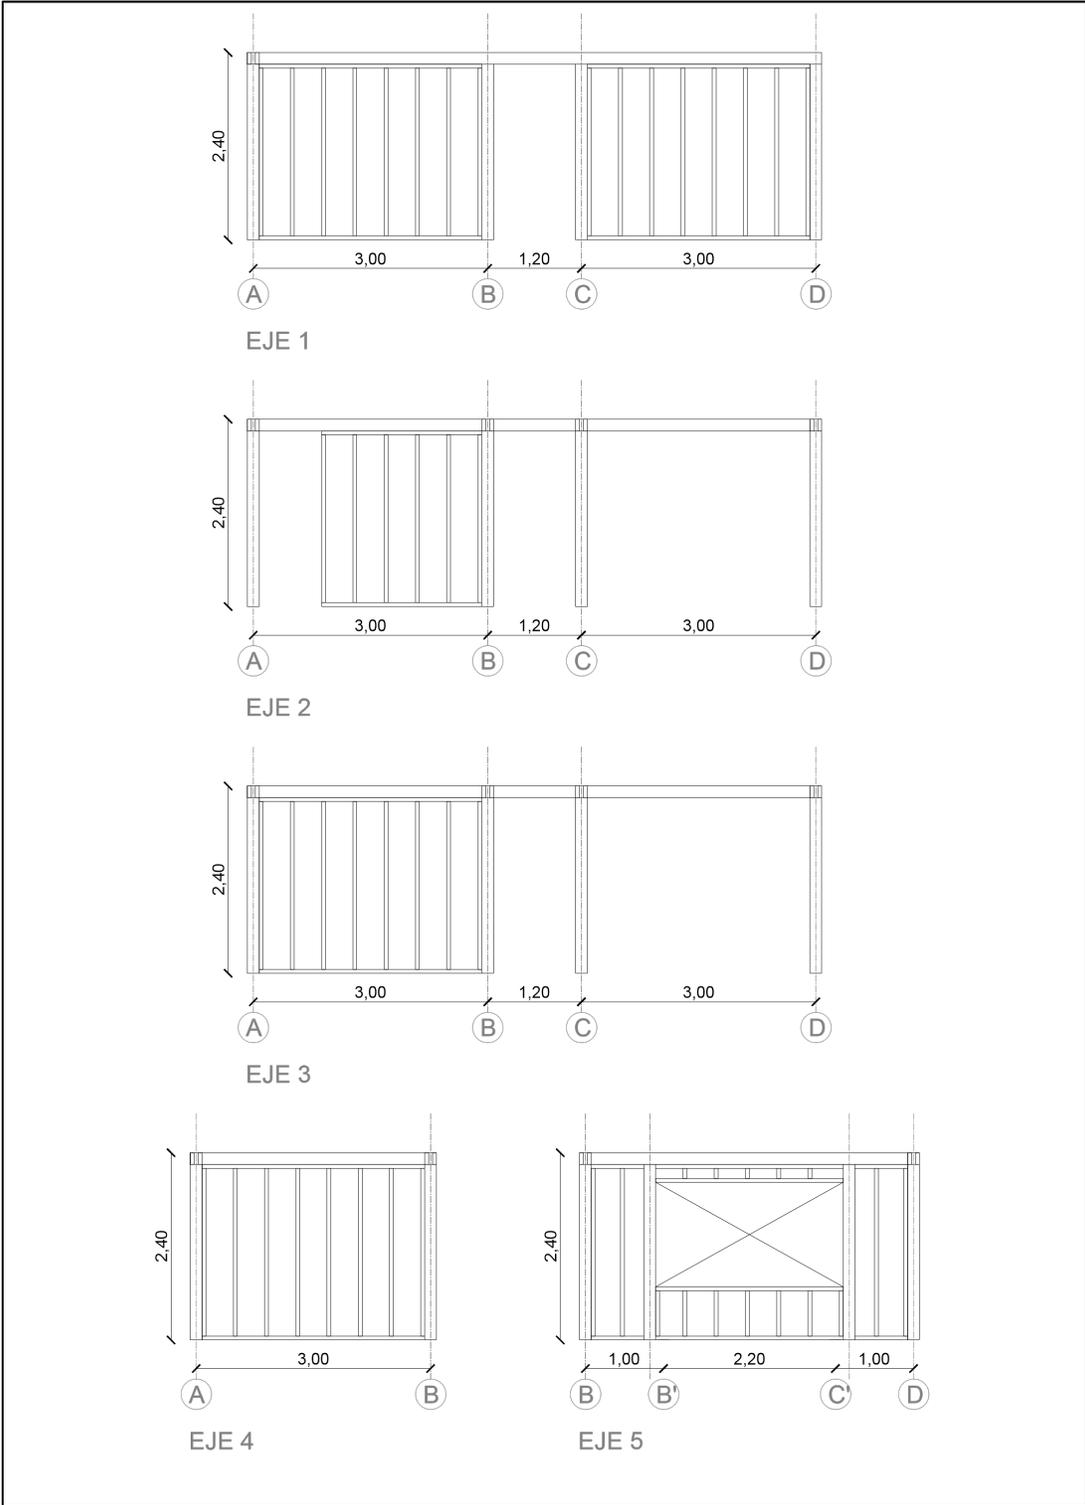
Elevaciones de estructuras modelo pilar-viga
